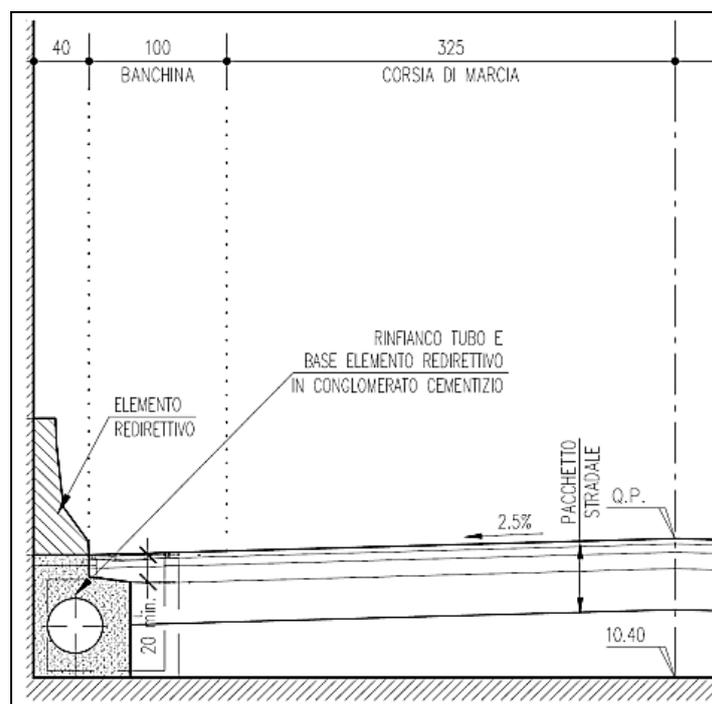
PARTICOLARE POSIZIONAMENTO CANALETTA
